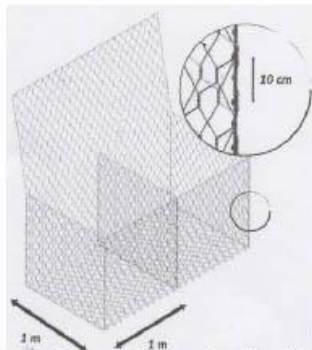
Amarrado de las aristas del gavión. Fuente: (ACEROS METALES Y MALLAS LTDA, 2016)
